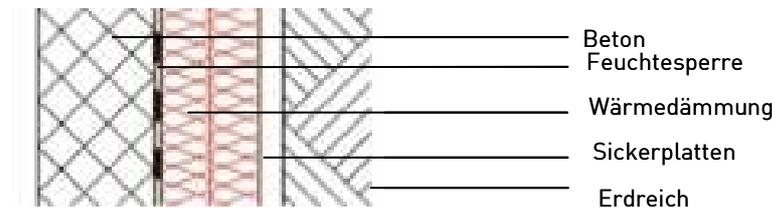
Aufbau der Gedämmten Betonwand mit einer Sickerplatte.
